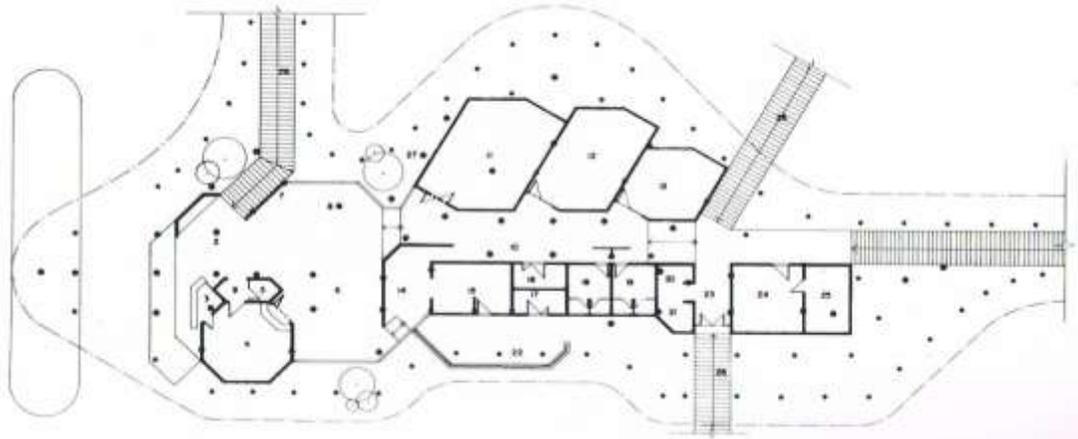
Planta da área da recepção com a solução de pilares independentes da planta racional. Fonte: ZEIN, 1990, p. 12.
